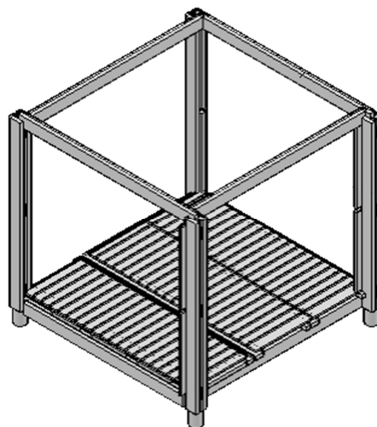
Esquema de la estructura resistente del módulo básico. Fuente: Documentación provista por TECHO.
